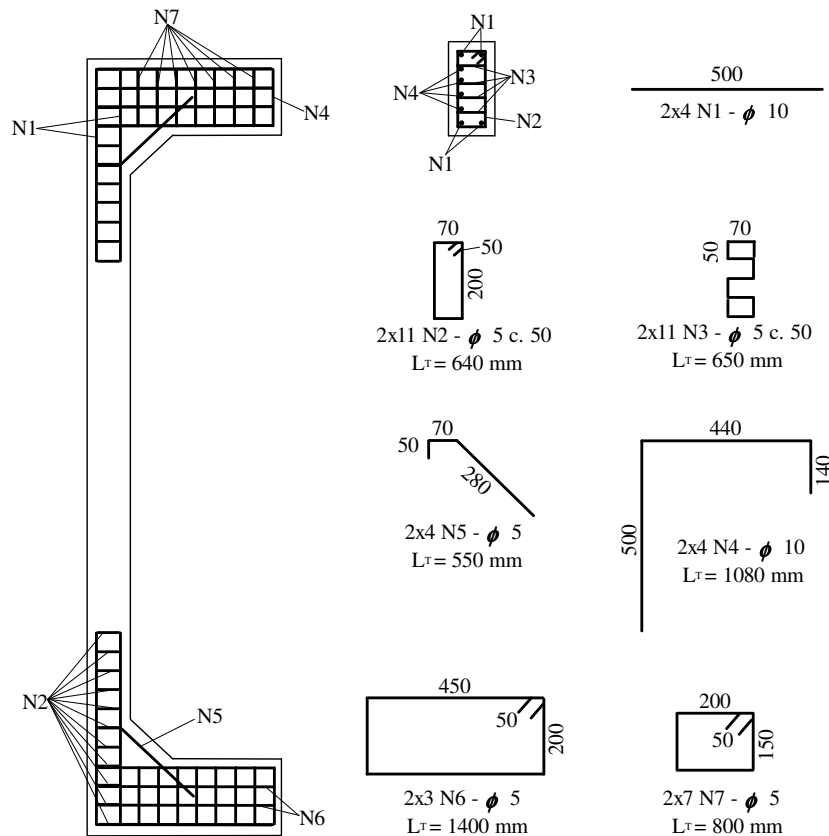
Detalhamento das armaduras dos pilares da Série PSA de ADORNO (2004)
